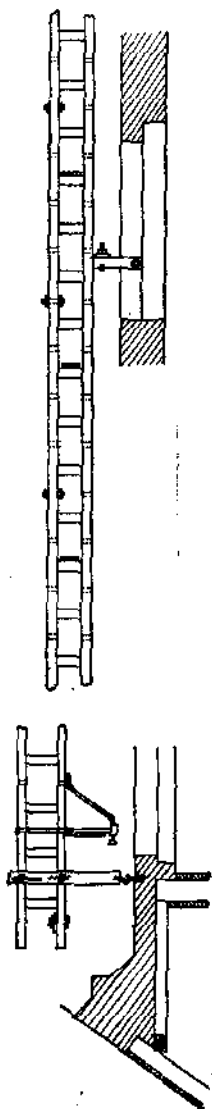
Леса лестничного типа. Схема устройства и детали соединений.
